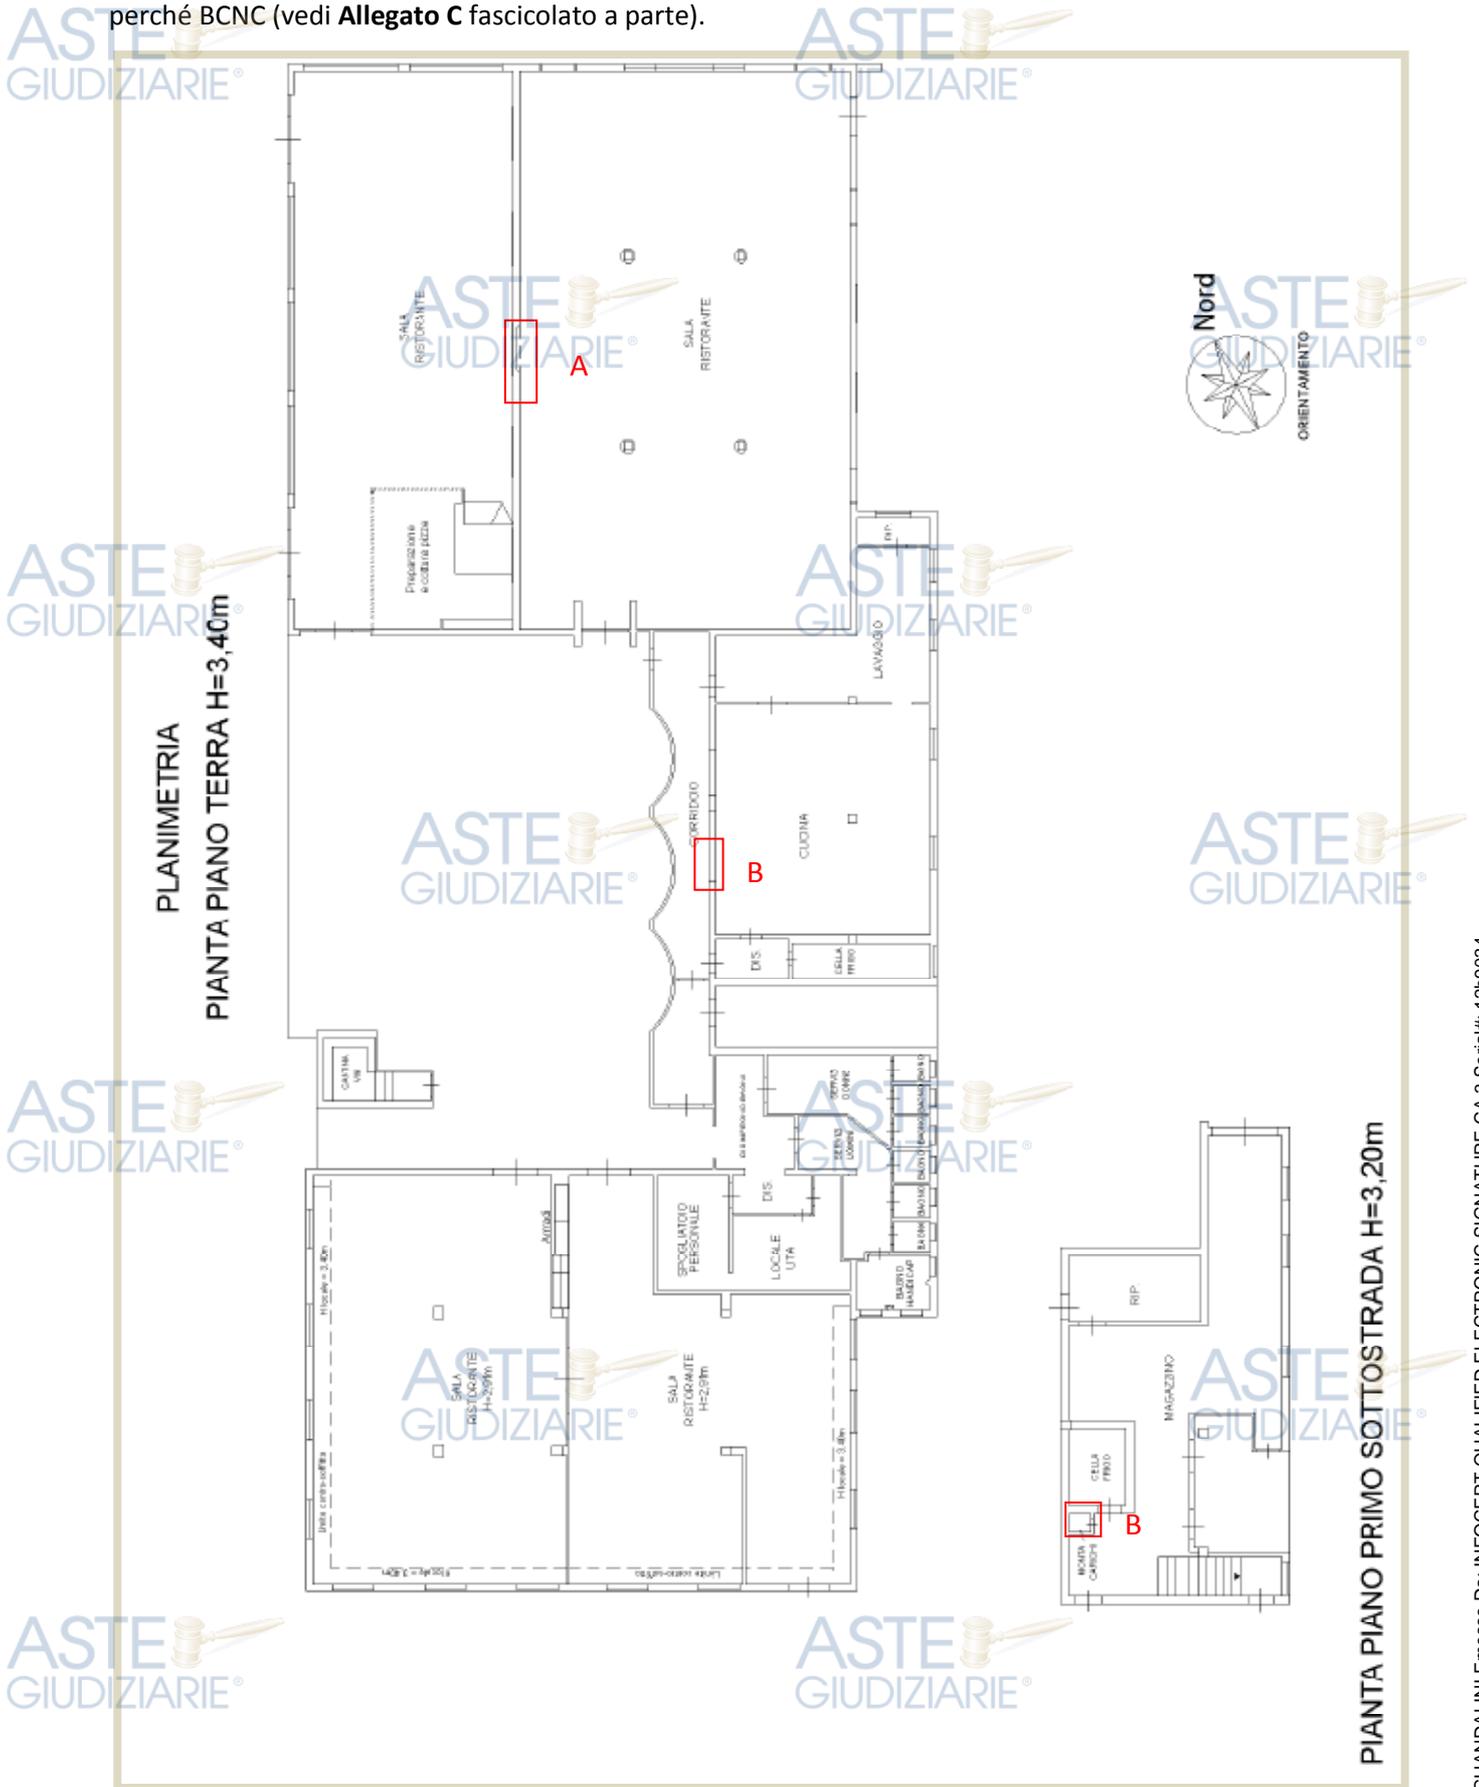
PIANTA PIANO TERRA E PORZIONE DEL PRIMO SOTTOSTRADA
